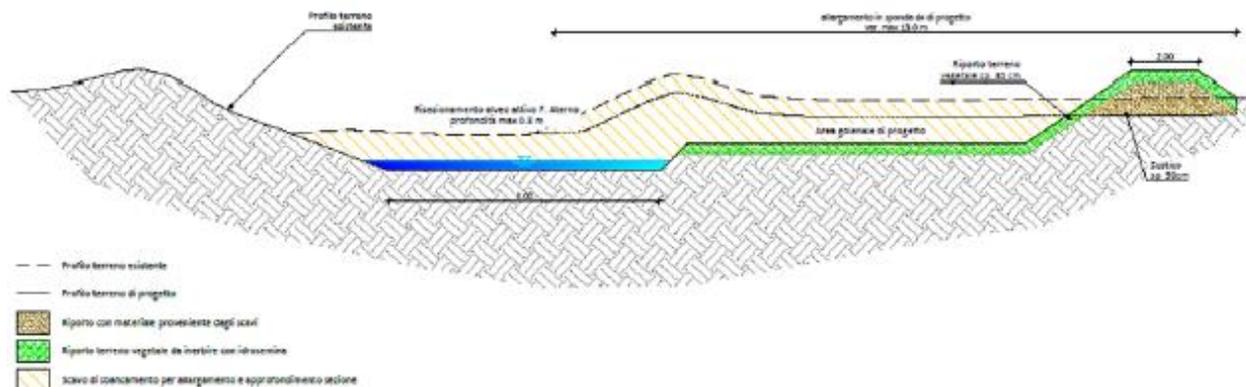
Stralcio planimetrico intervento di risezionamento in comune di Tione degli Abruzzi.
